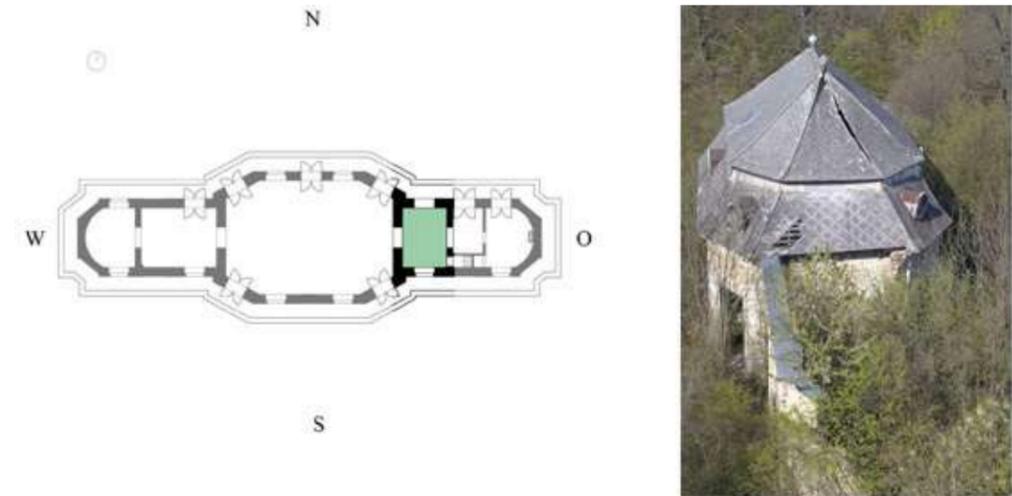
Lage im Grundriss, Gesamtübersicht des eingestürzten Seitenflügels
